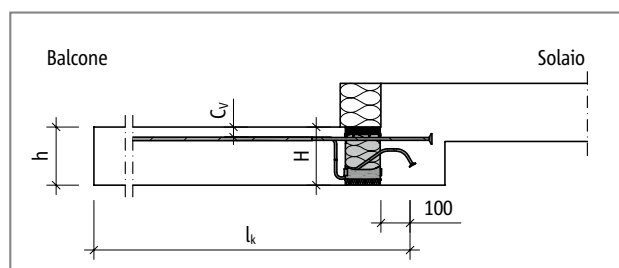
Schöck Isokorb® XT tipo KL-U: schema statico
